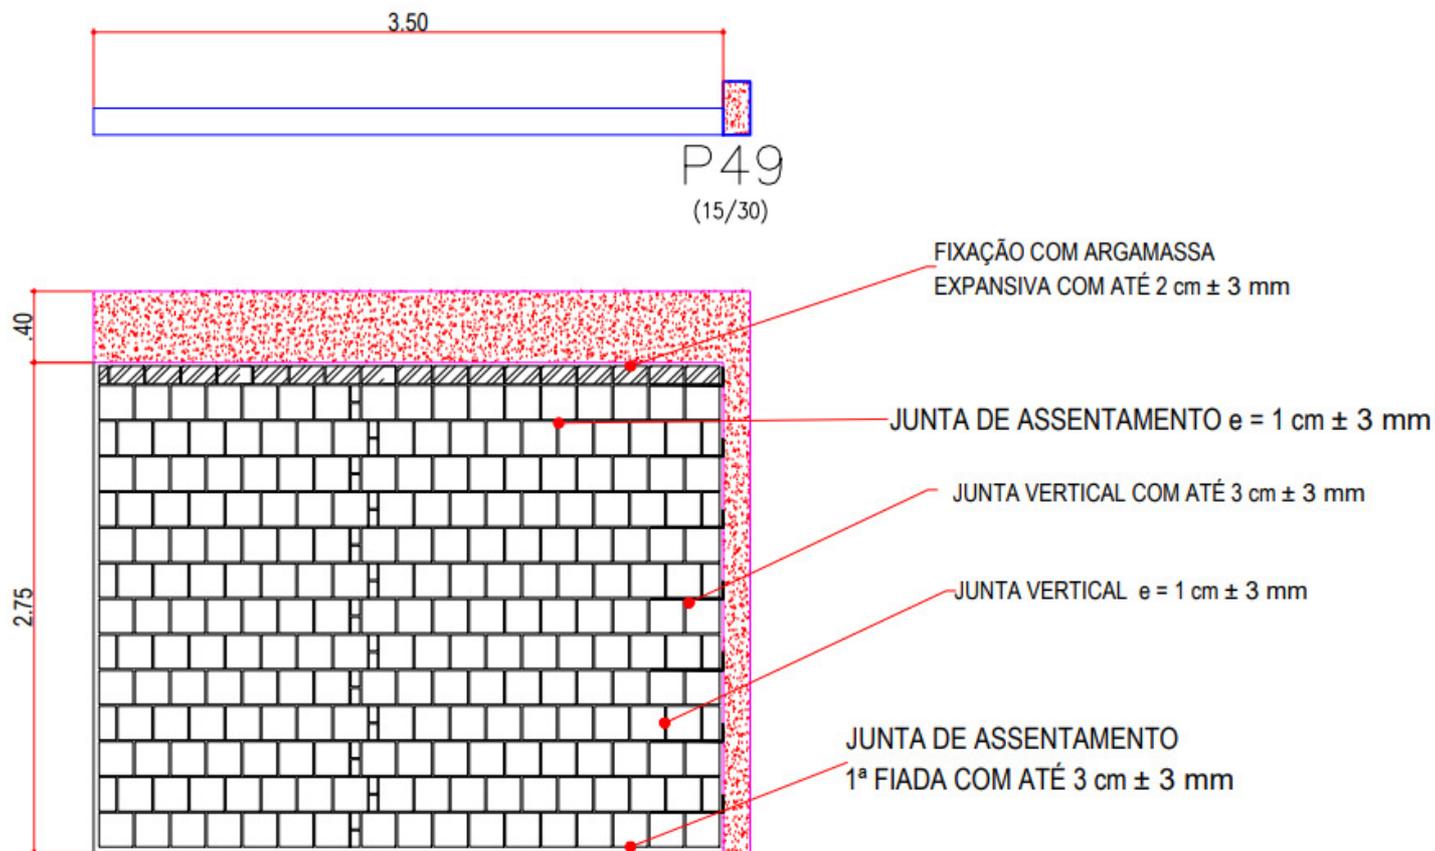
Vista 3 do Estúdio Gravação (Locução)
